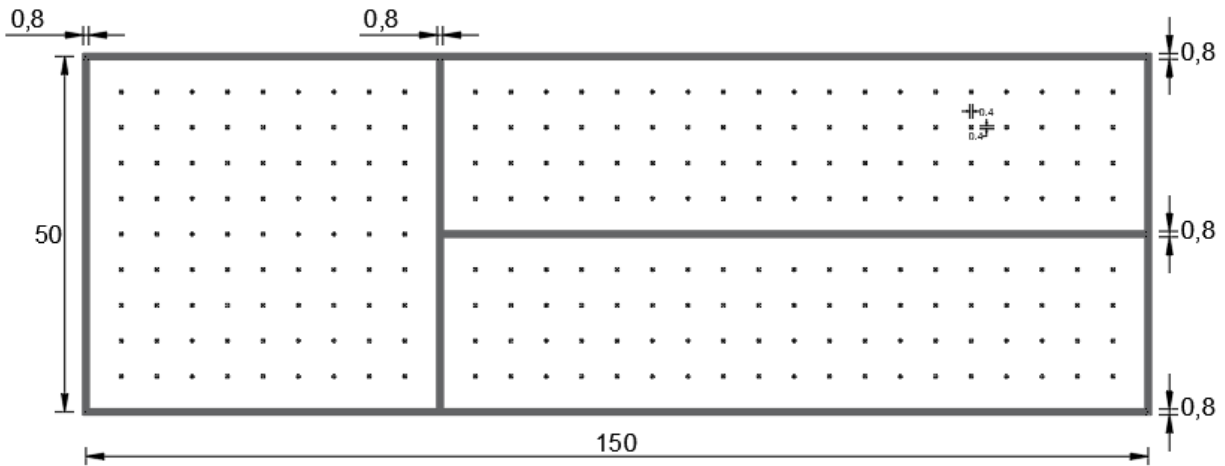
ESQUEMA FINAL DE LA PLANTA DEL DEPÓSITO: FUENTE: ELABORACIÓN PROPIA.
